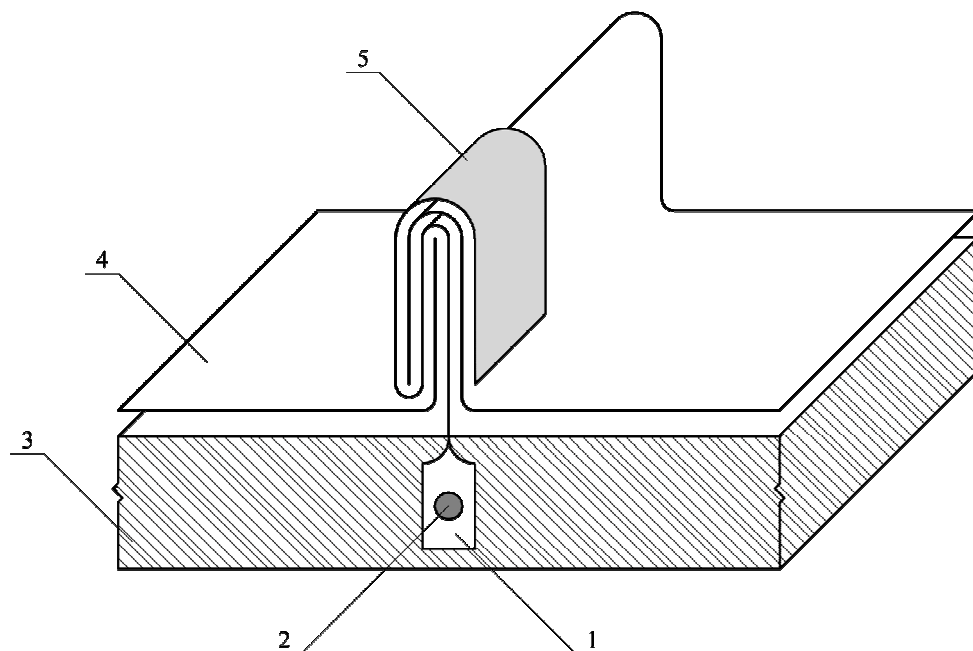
Схема крепления кляммера к обрешётке:
